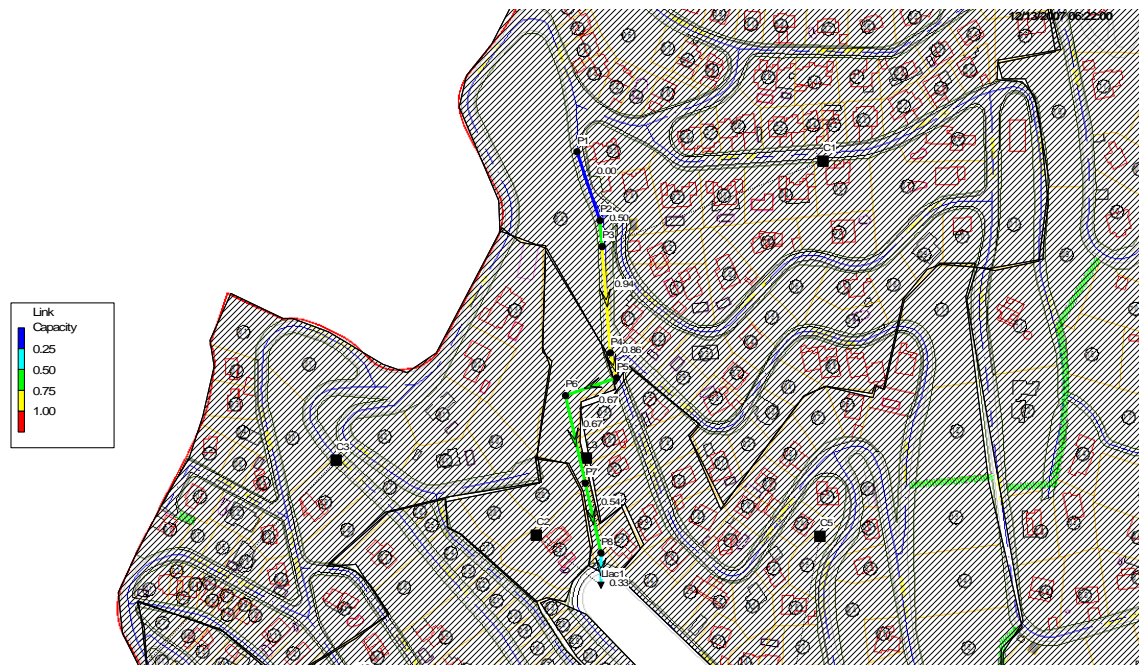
Vista en planta del grau d'ompliment dels col·lectors
